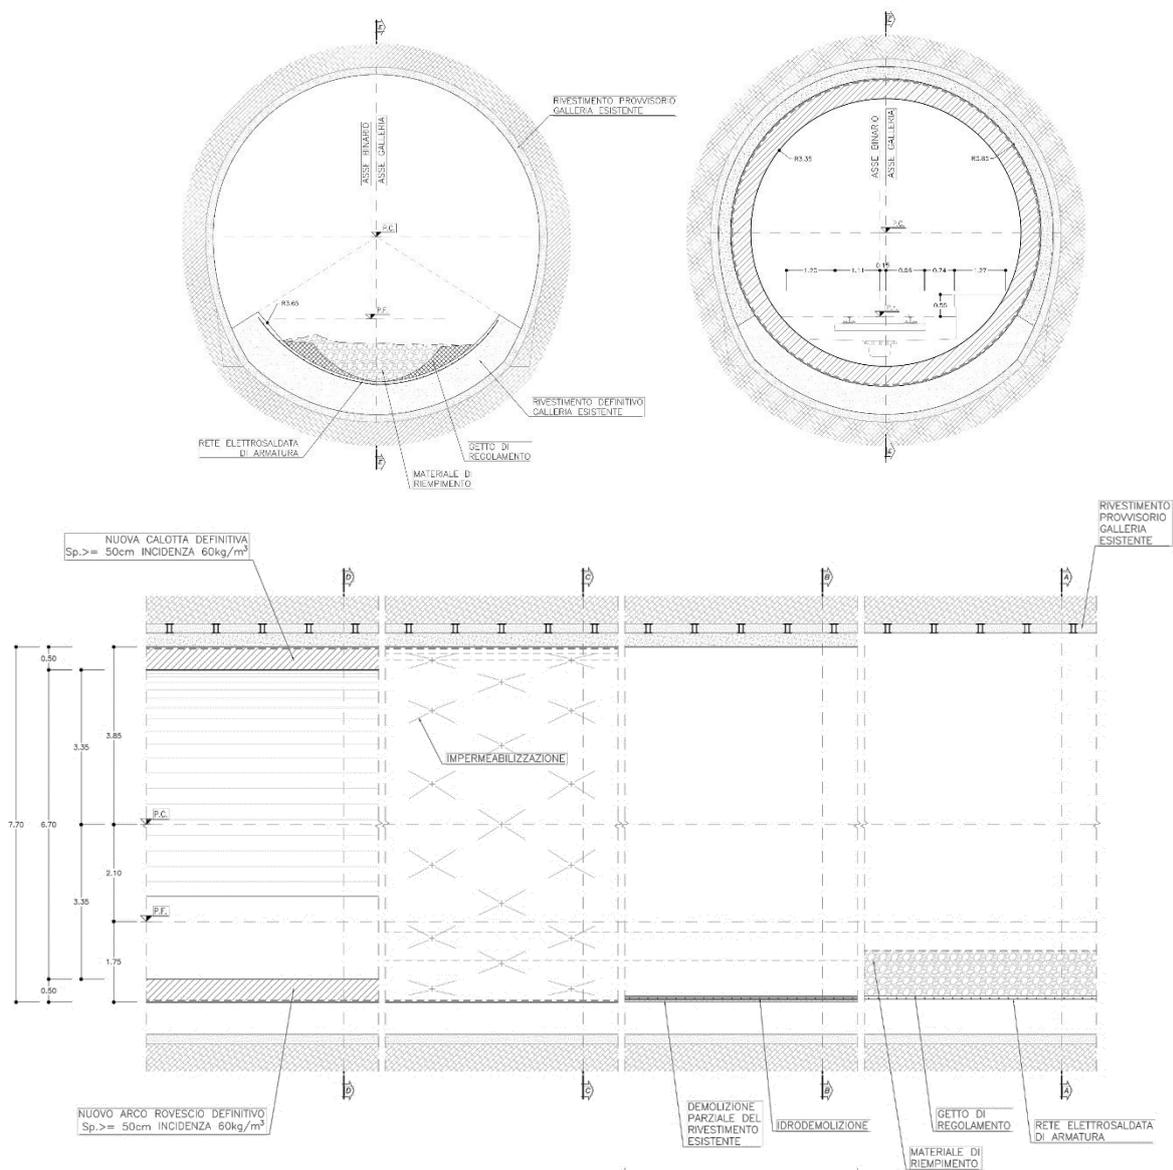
Sezione 6: sezione trasversale attuale (in alto a sinistra) e di progetto (in alto a destra) e profilo longitudinale (in basso) della Galleria con indicazione degli interventi previsti (da [2.13])
